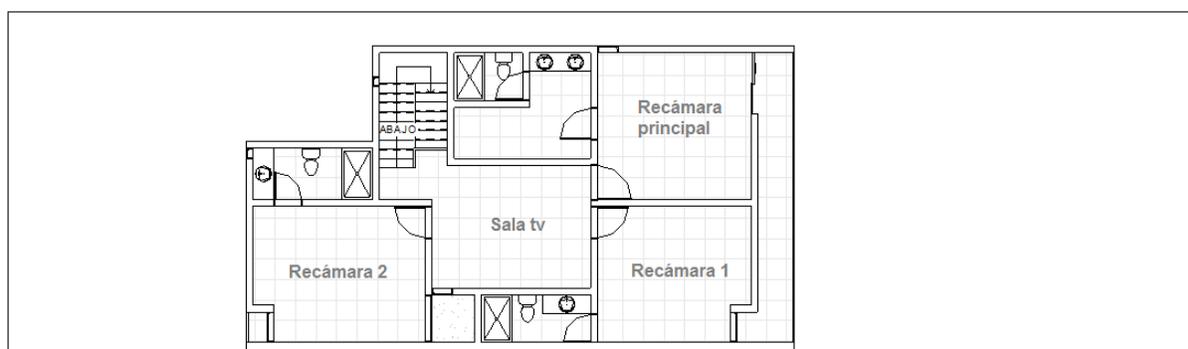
Croquis de vivienda tipo residencial plus, en planta alta
